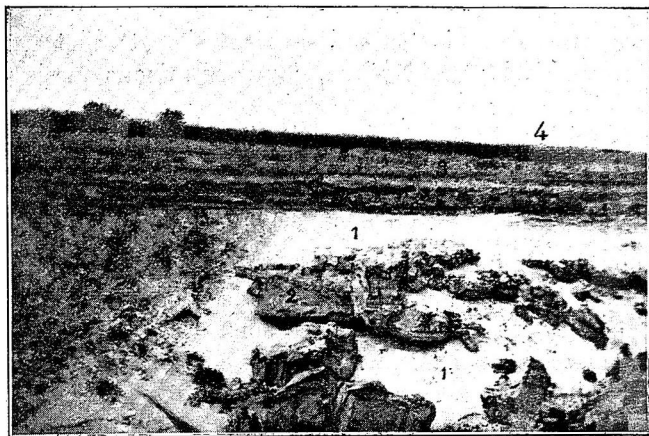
VUE DU FRONT D'EXPLOITATION DE LA CARRIÈRE D'ORMESSON
